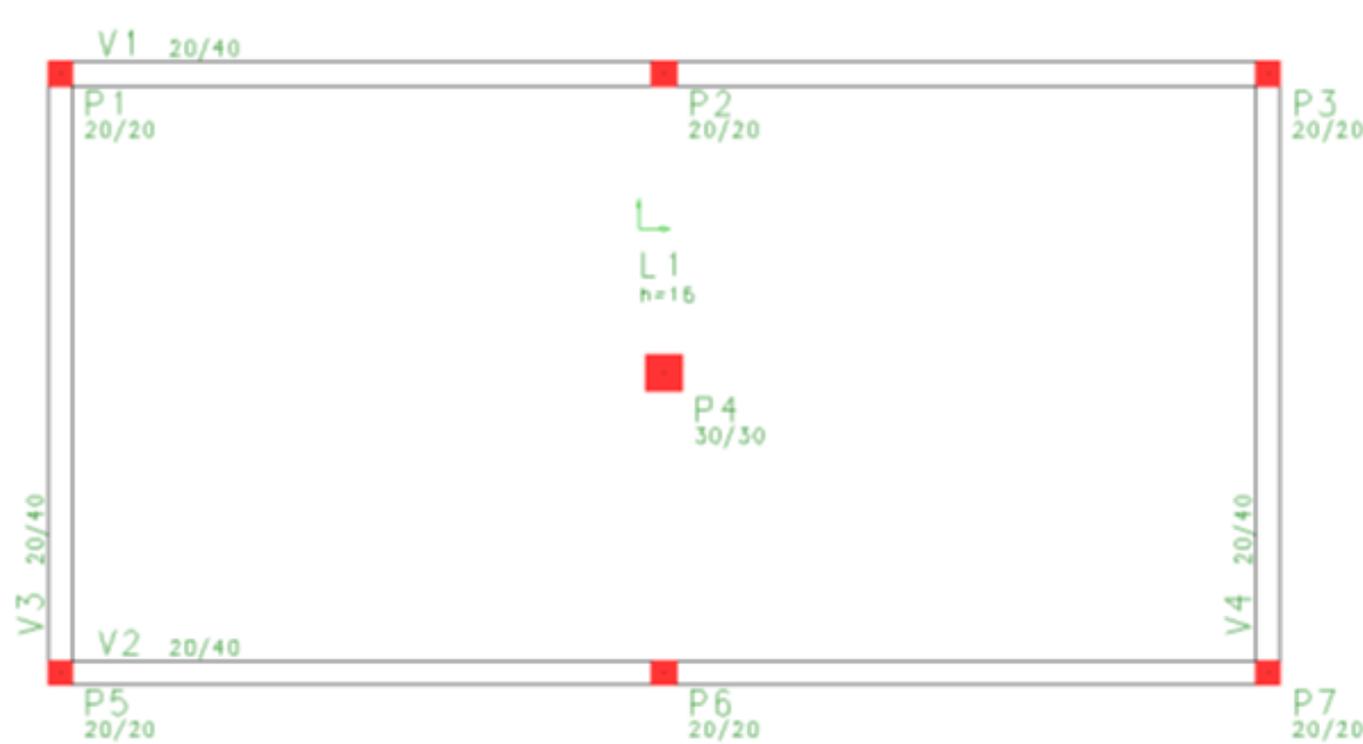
Lançamento de laje maciça no Modelador Estrutural
